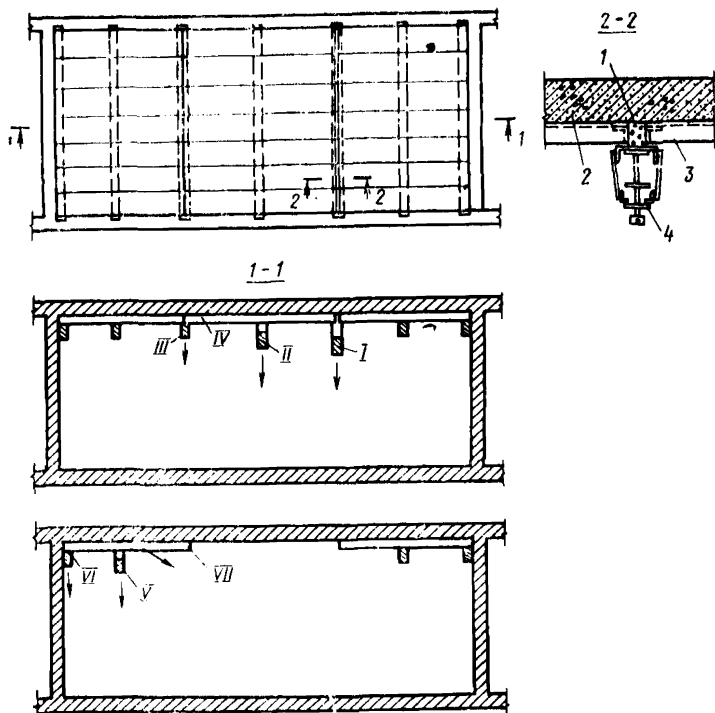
Порядок демонтажа раздвижных ригелей при распалубке железобетонных перекрытий (римские цифры обозначают последовательность операций)
